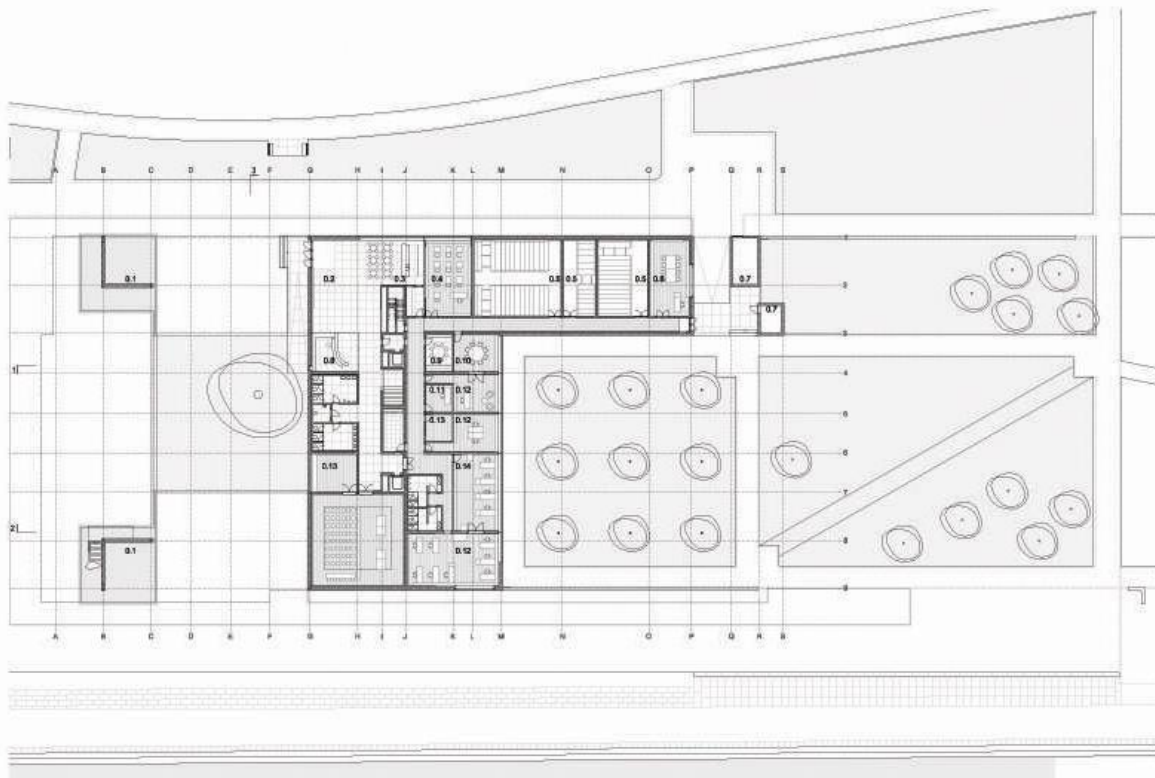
Planta Baja, Biblioteca Viana Do Castelo
